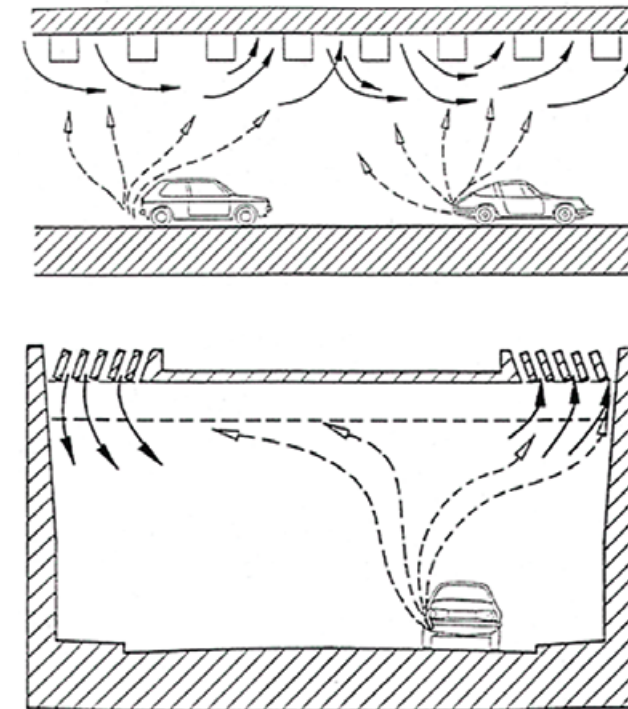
/26 Leichtbaulärmschutz tunnel, Beleuchtung, Belüftung
